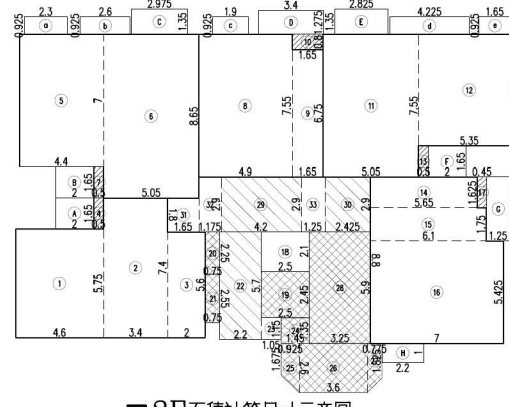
地上 2 層平面圖 (比例尺 1/200)
